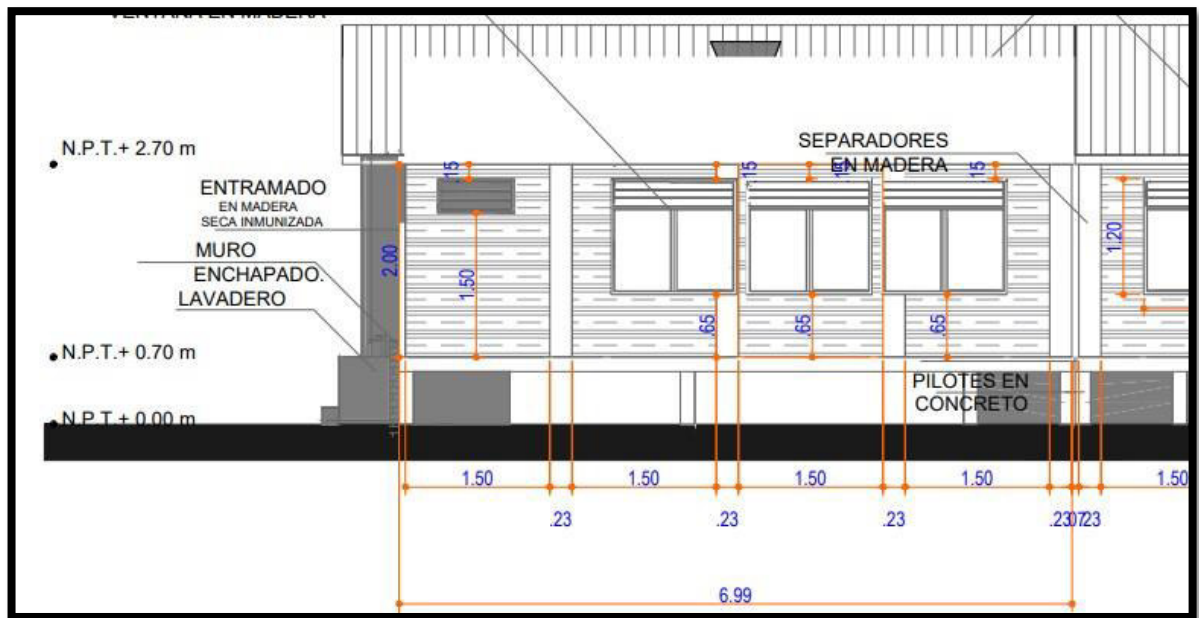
Fachada posterior del MVRA. Fuente: Elaboración propia
